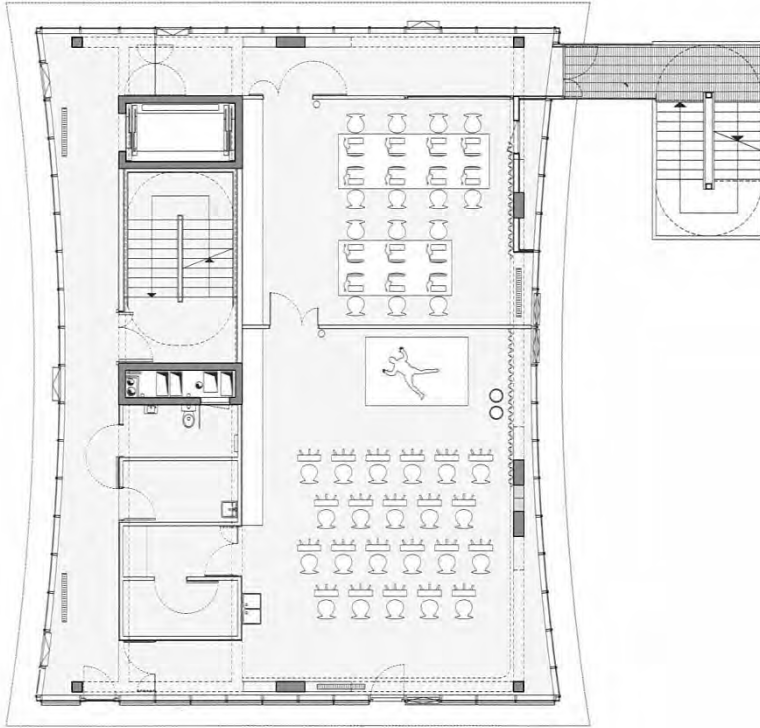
Planta segunda del Centro Wangari Maathai, 2010-2014
